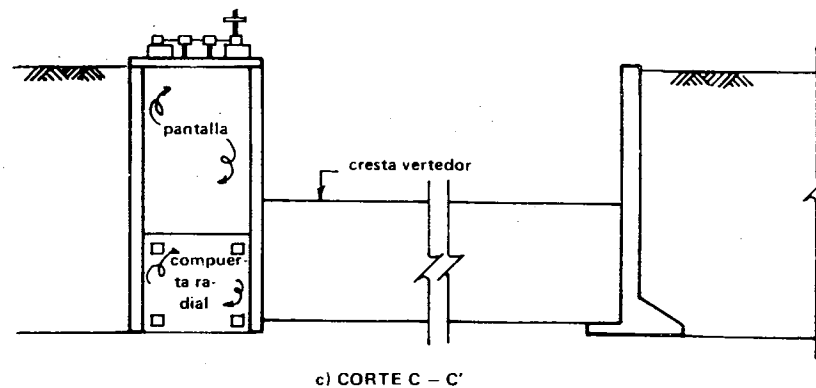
Corte CC'. Vista de canal desarenador y cortina vertedora.
